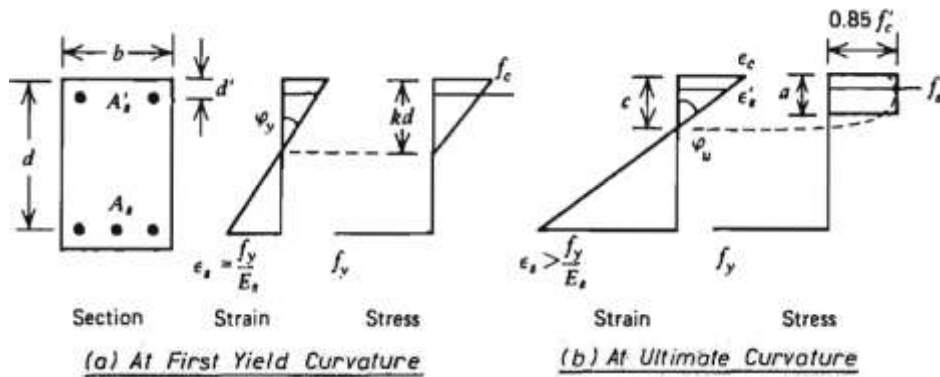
Sección de viga doble refuerzo en concreto no confinado sometida a Flexión, ref[9] pp 204.
